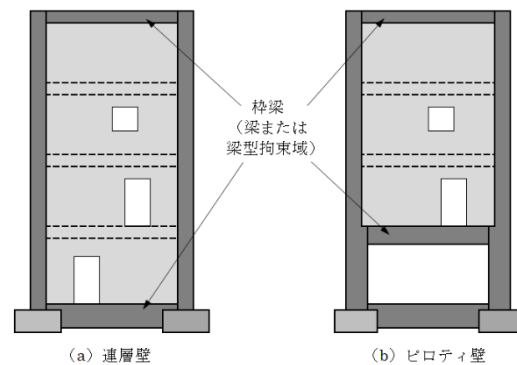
断面と配筋の検討が必要になる枠柱および枠梁
